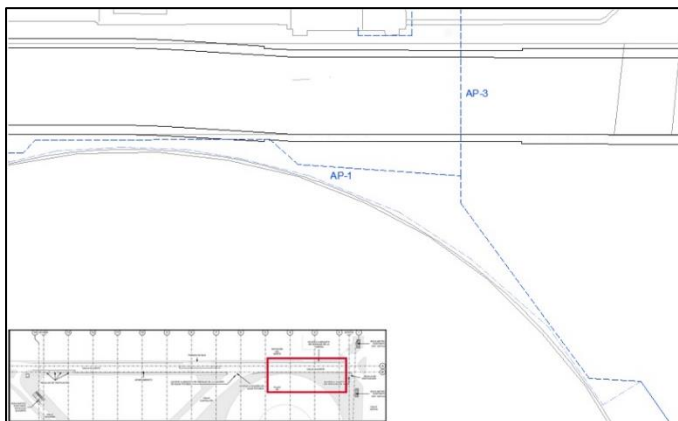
Plano de reposición AP-ALTA-AP1-SR-CX-F8. Zona final
